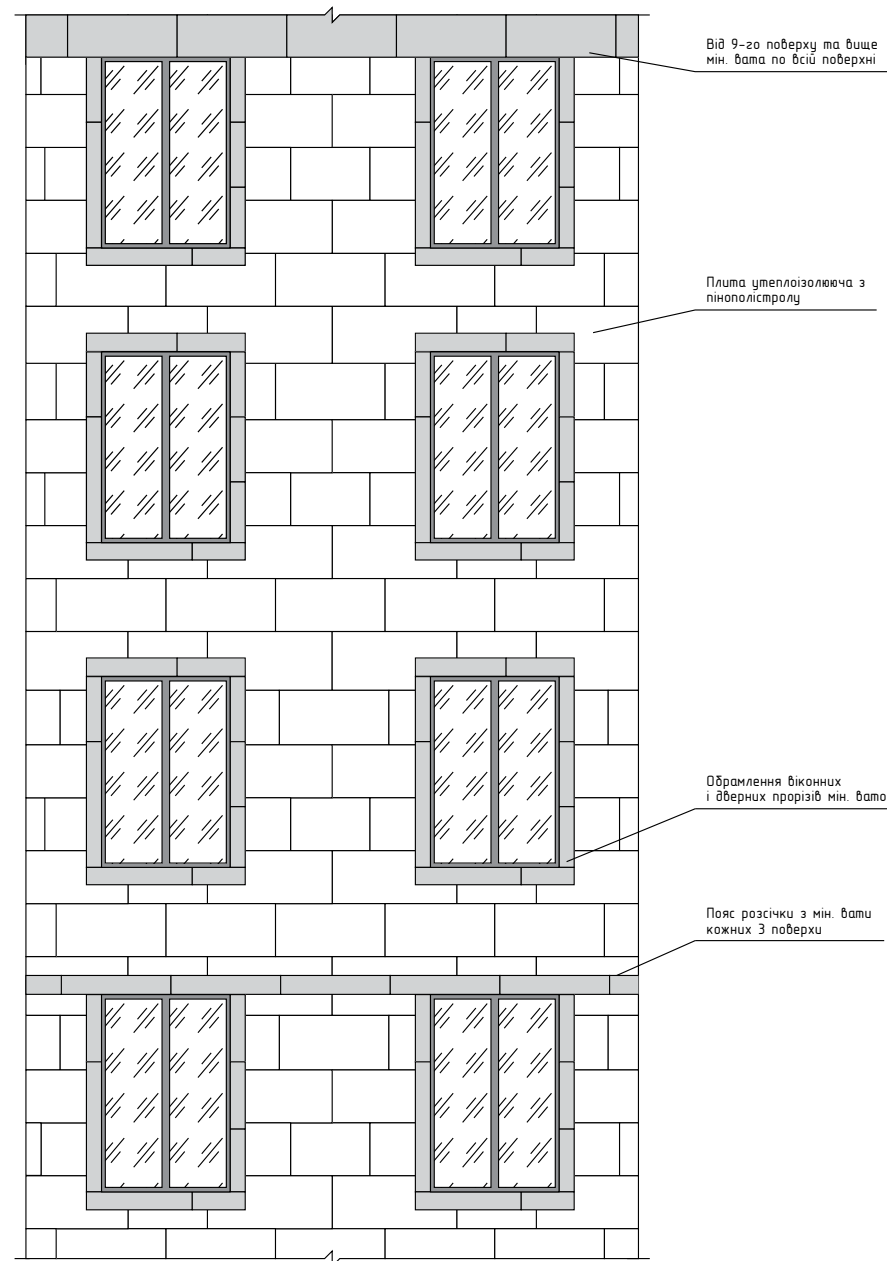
Схема розташування плит утеплювача, поясів розсічок у будинку до 25 поверхів
